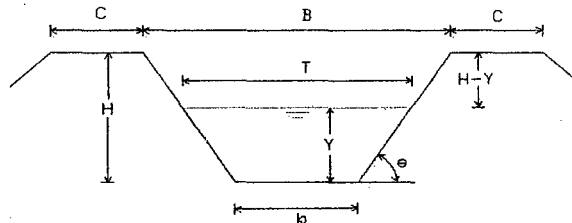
ELEMENTOS GEOMETRICOS DE LA SECCION TRANSVERSAL DE UN CANAL
